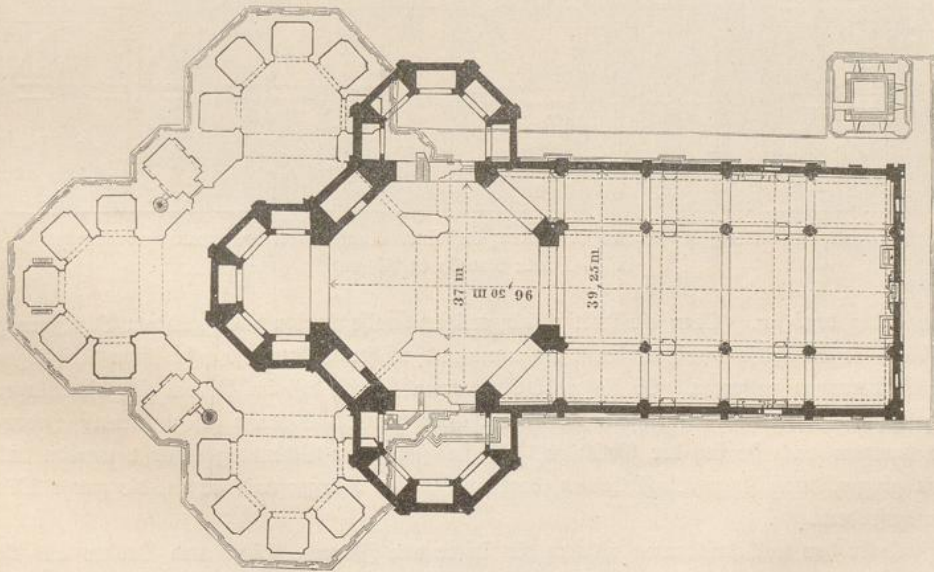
Grundriß des Domes zu Florenz. (Die dunklere Zeichnung bezeichnet den ursprünglichen Plan.)
